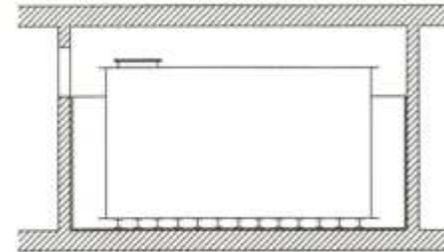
Bei über 5.000 l Fassungsvermögen ist ein Lagerraum vorgeschrieben.
